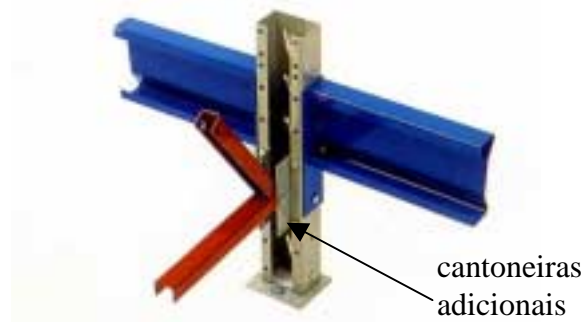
Foto de uma coluna de seção transversal U enrijecido com cantoneiras adicionais para instalação dos contraventamentos, (Isma (2000)).
